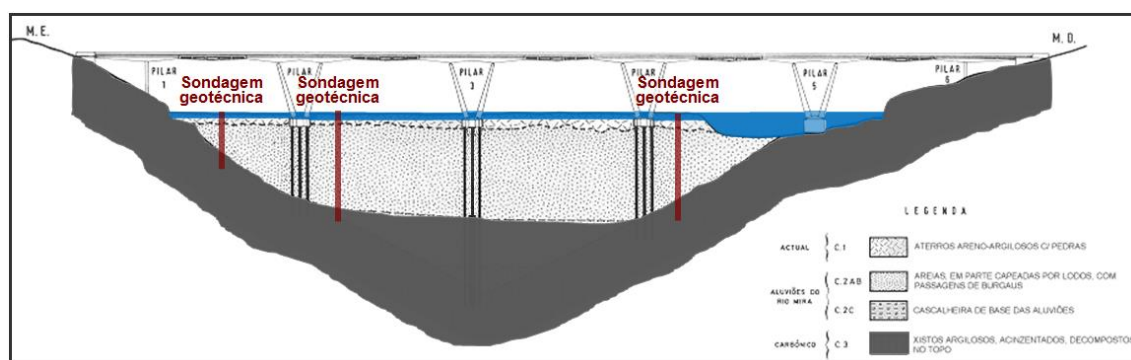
Corte longitudinal ilustrando a implantação da ponte sobre o perfil geológico interpretativo
